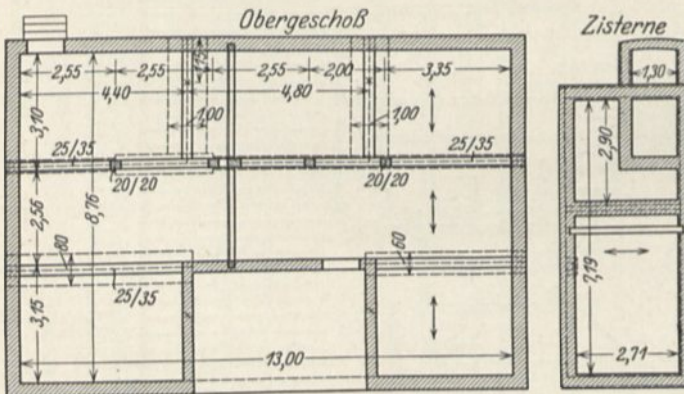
Stallgebäude in Connhausen. Obergeschoßdecke (Kornspeicher) und Zisterne (zu Abb. 105).
